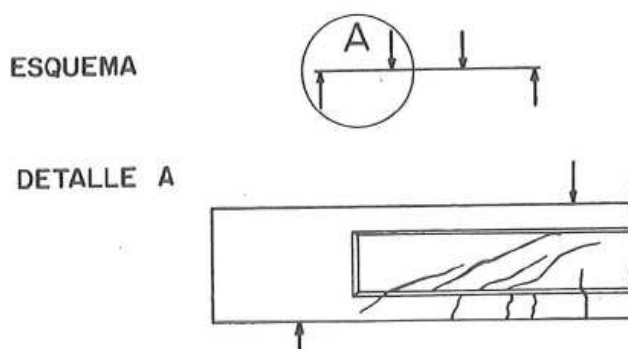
Fisuración en vigas en doble "T" pretensadas sin armadura transversal (Sozen)
